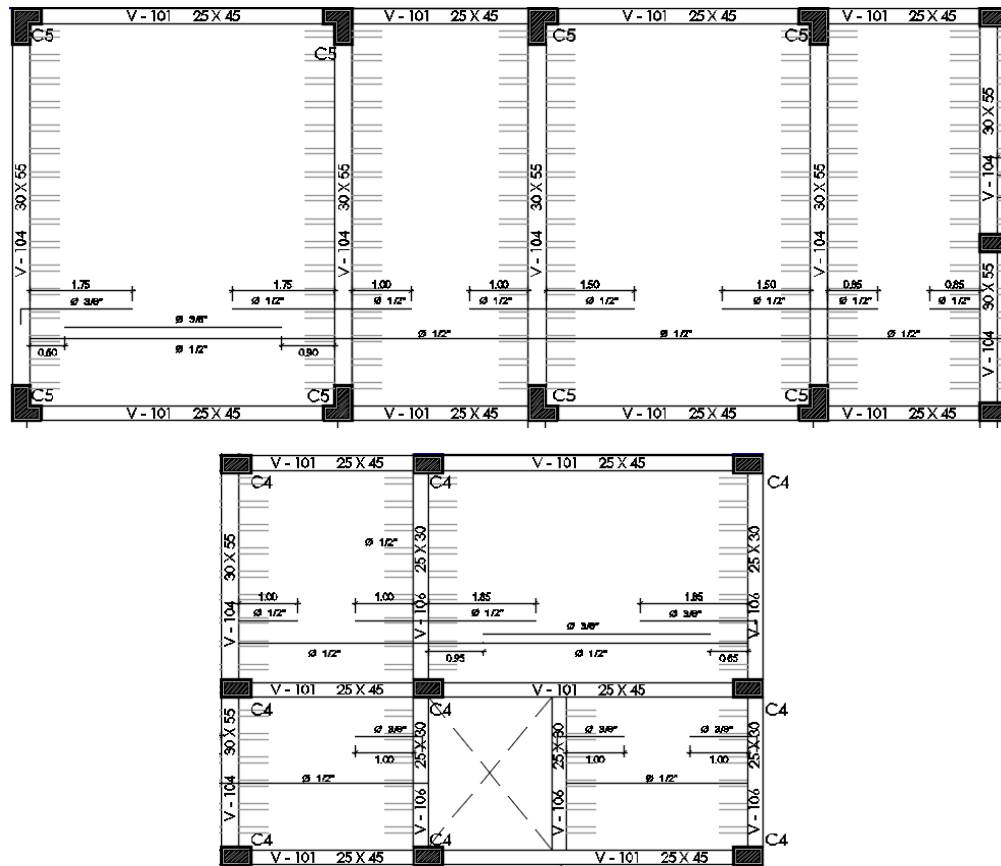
Sección de acero en losa L1-L5, del sector desarrollado
